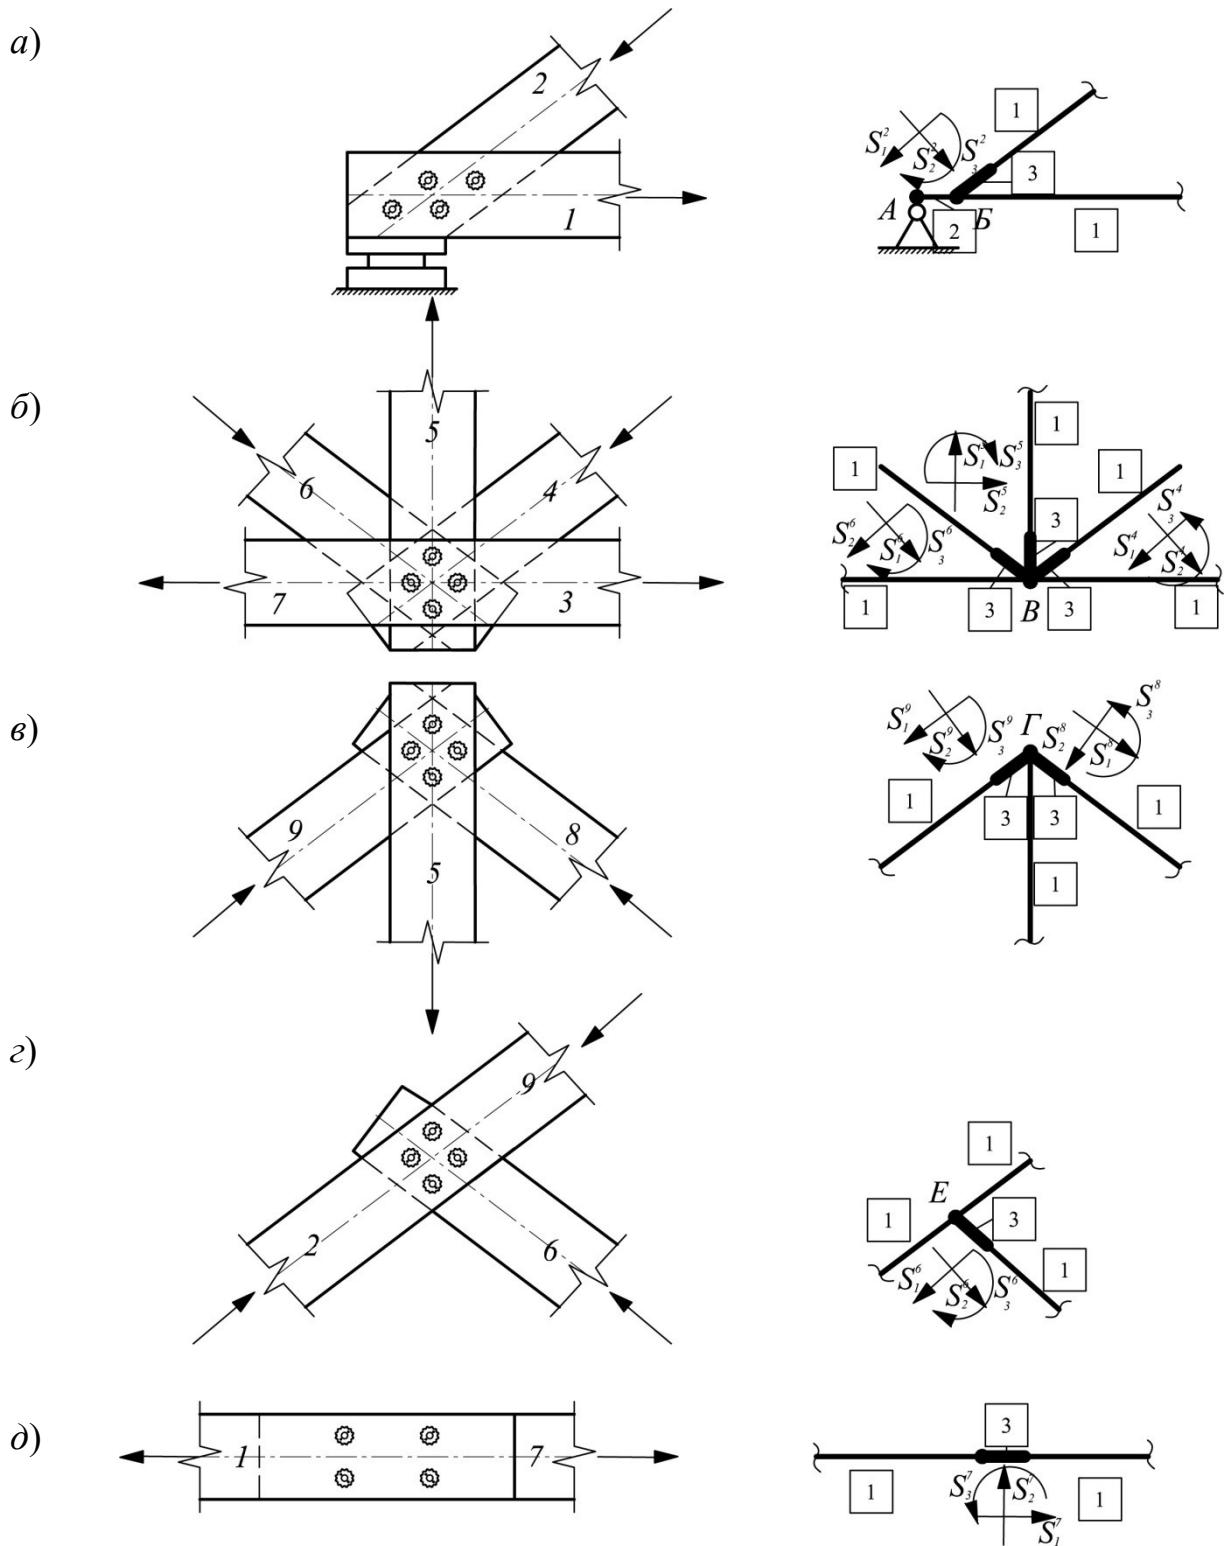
Схемы к расчету соединений в конструкциях ферм, с обозначением номеров стержней и принятых типов конечных элементов (в квадратах): а) узел соединения верхнего и нижнего пояса; б) узел соединения нижнего пояса, раскосов и стойки; в) узел соединения стойки и верхнего пояса; г) узел соединения верхнего пояса и раскоса; д) узел соединения элементов по длине.
